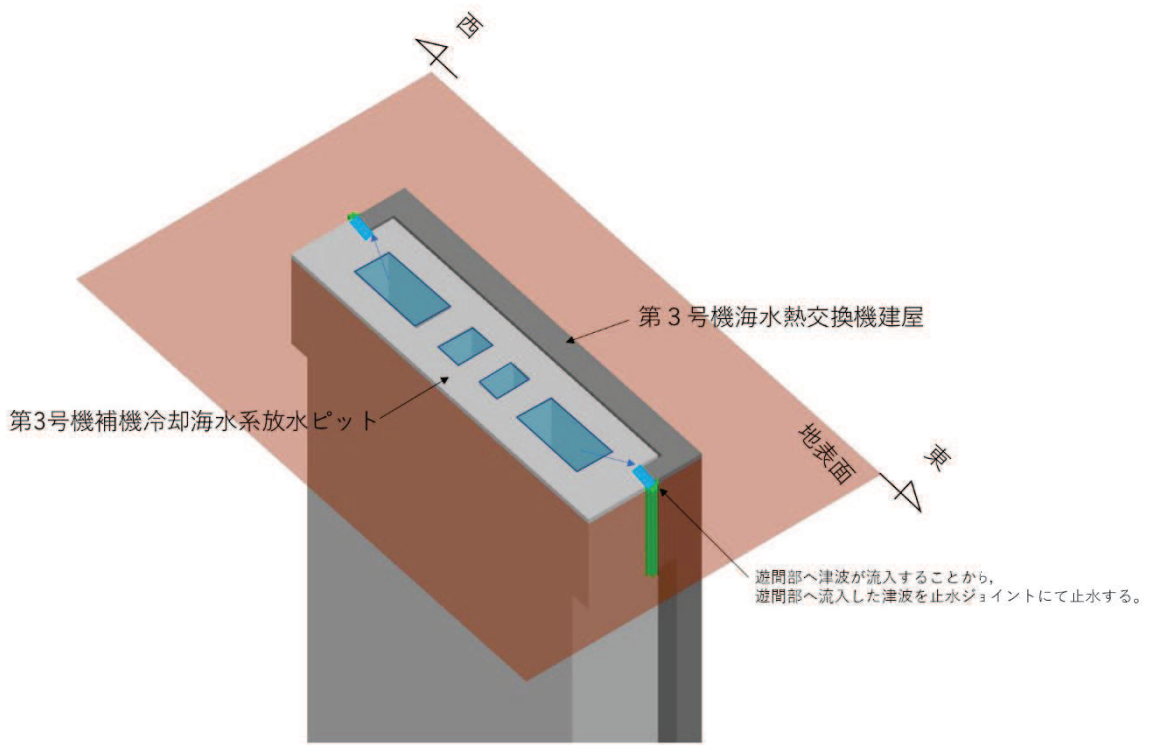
第 3 号機補機冷却海水系放水ピット平面図 (C-C 断面)
